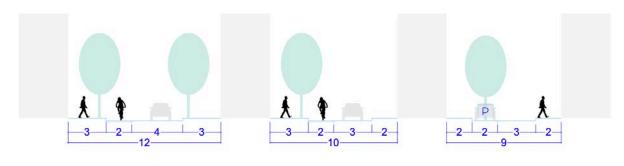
Sección de calle a escala de barrio. Cotas en metros lineales (m)
